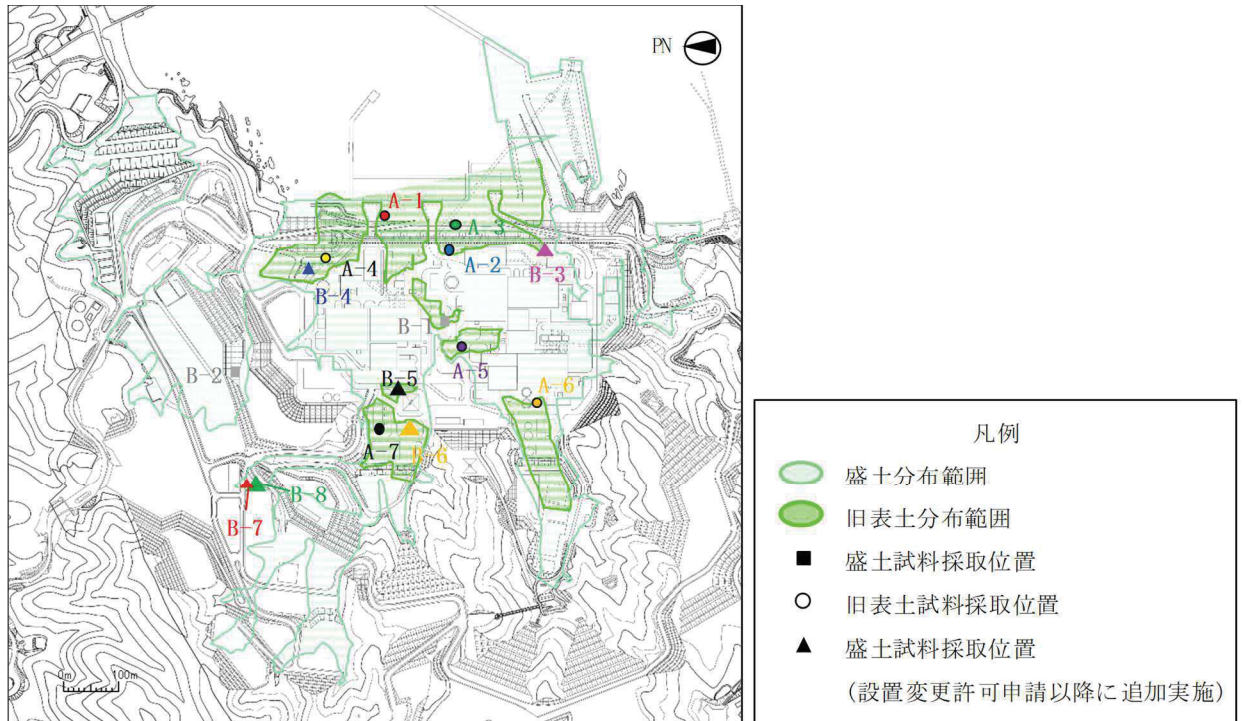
旧表土及び盛土の液状化強度試験位置並びに旧表土及び盛土の分布範囲の平面図
